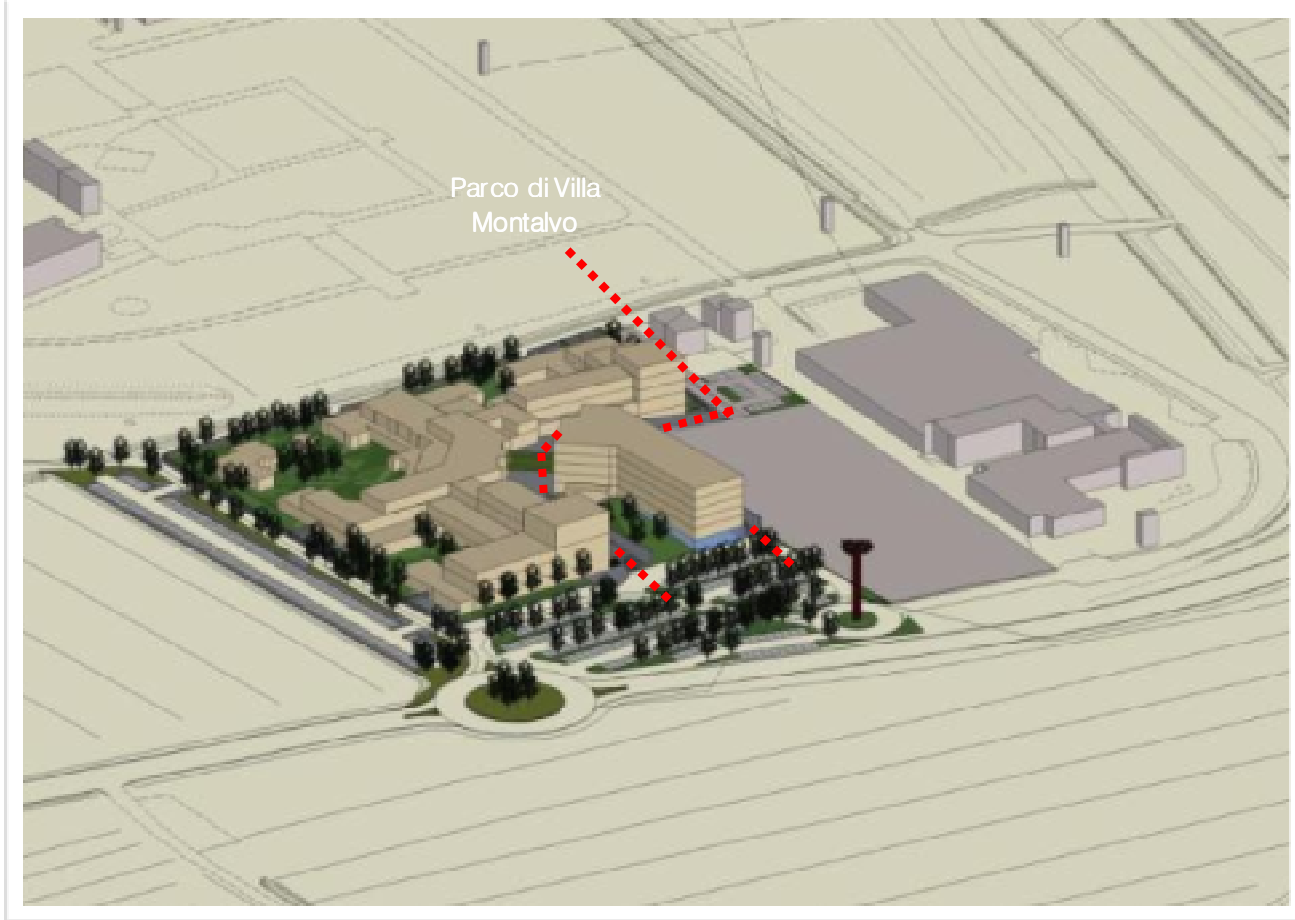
Il sistema di connessione (tratteggio in rosso) Parco Montalvo - Progetto
